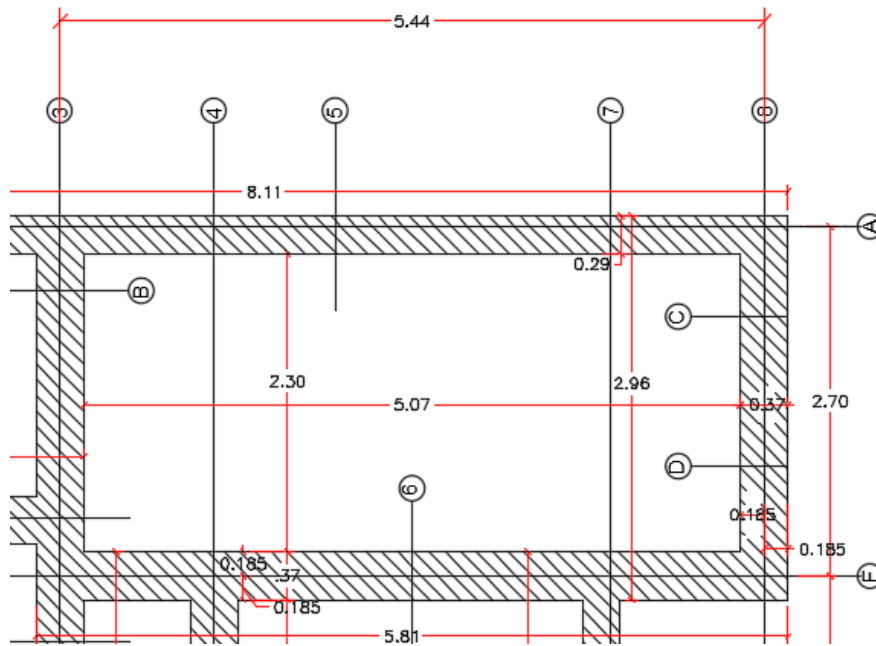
Ampliación de configuración en planta de la cimentación.
